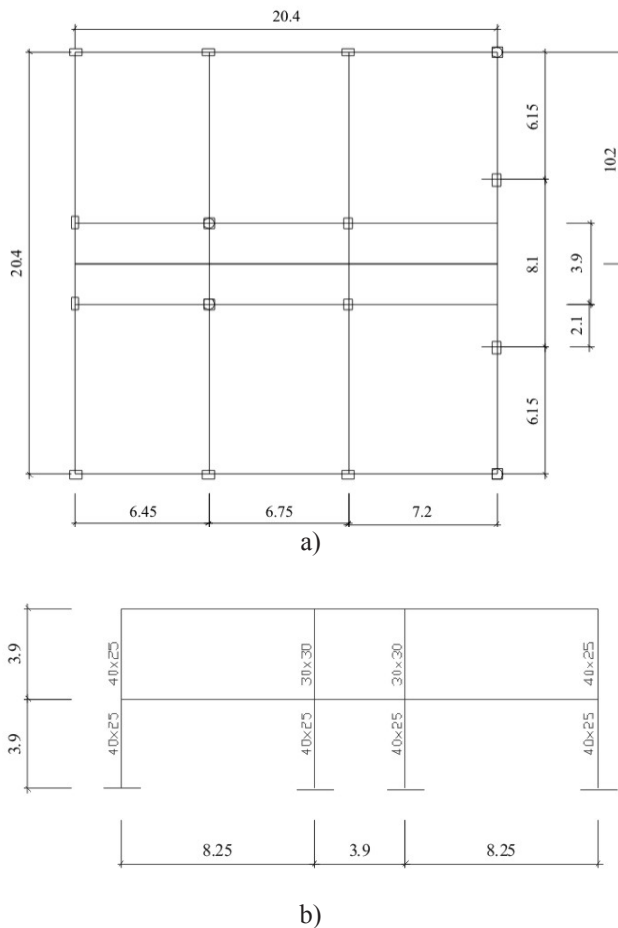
a) Planta de los edificios RCH, RCM, RCL. 1b) Alzado pórtico 2 edificio RCH.
